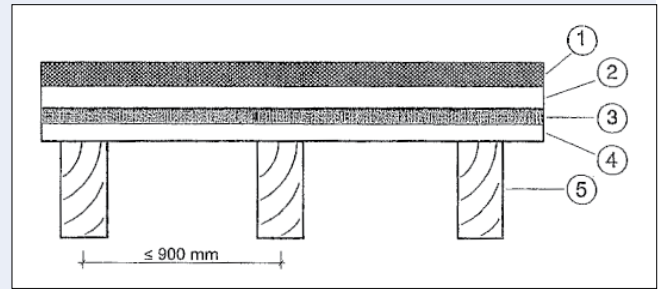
Prinzipskizze Gussasphaltestrich für Holzbalken-Deckenkonstruktionen
